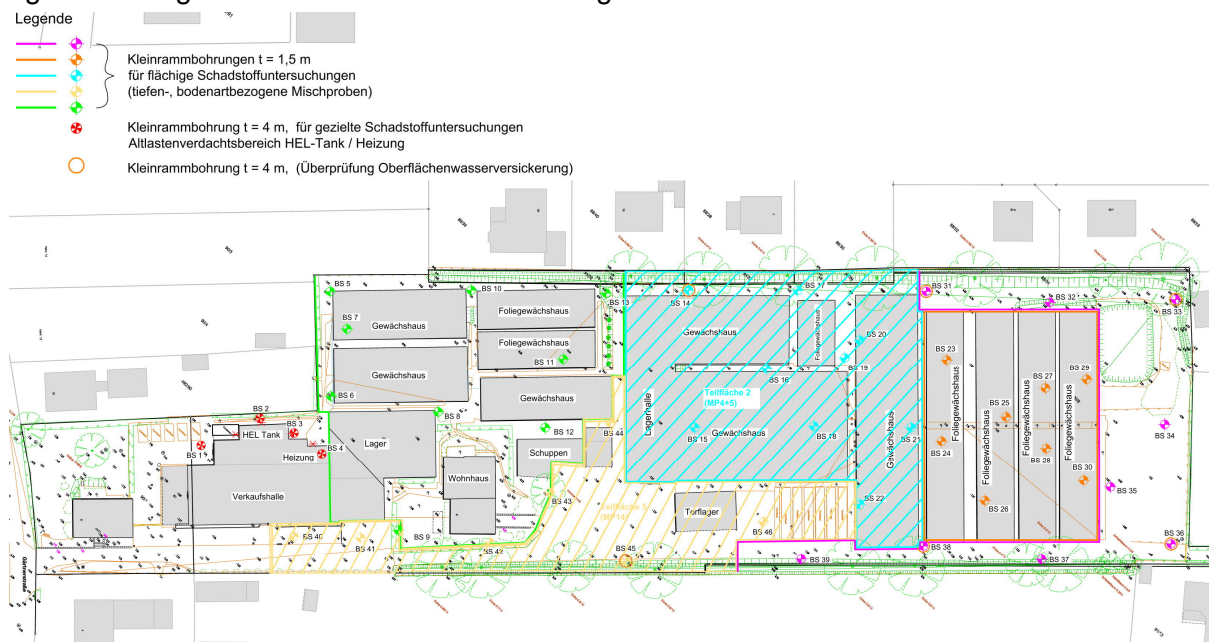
Lageplan der Baugrundaufschlüsse
